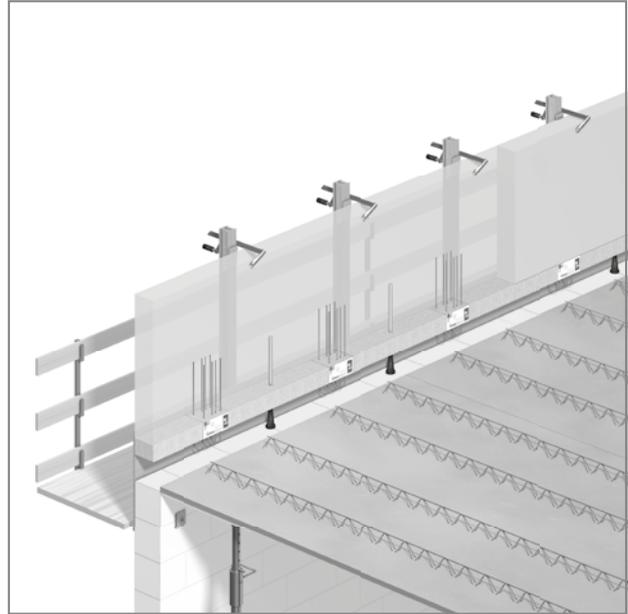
Schöck Isokorb® XT type A with Combar® FT erection support: Securing of the aligned precast concrete parapet
